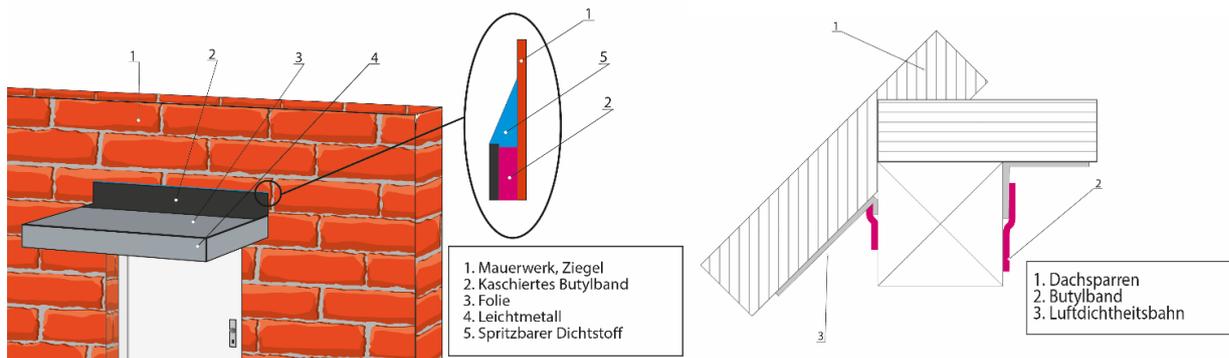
Abdichtung Hausvordach zur Wand und Luftdichtheitsbahn Dach (innen)
